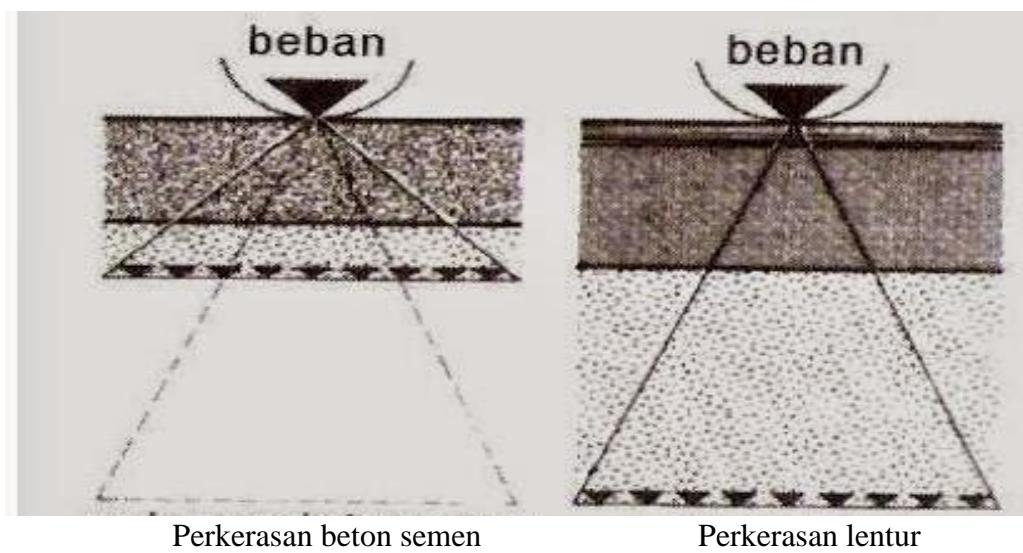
Potongan konstruksi perkerasan kaku (*Rigid pavement*)
